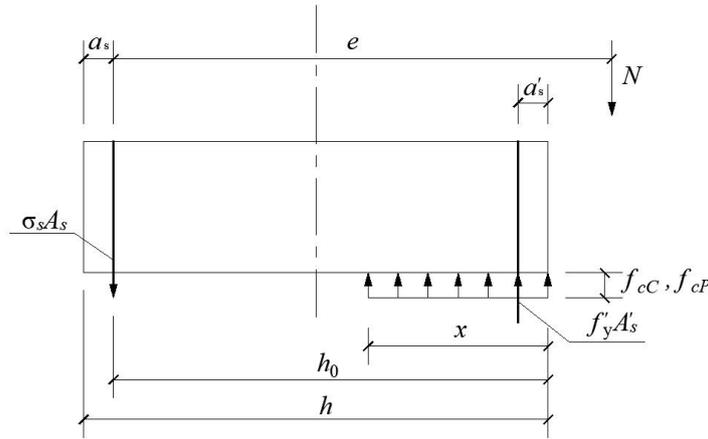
矩形截面偏心受压 3D 打印模板配筋混凝土构件正截面受压承载力计算示意图
